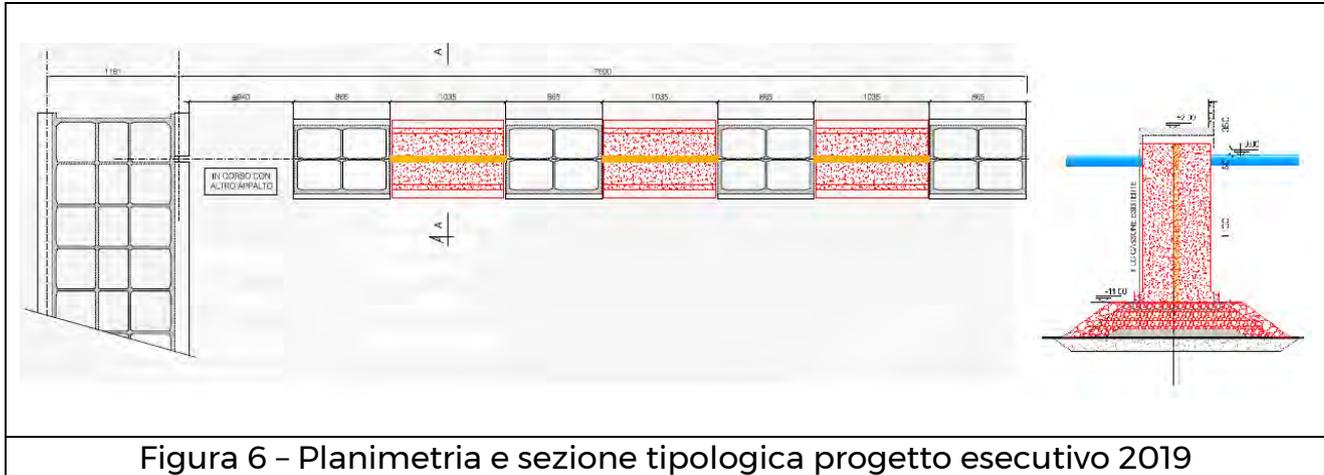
Planimetria e sezione tipologica progetto esecutivo 2019
